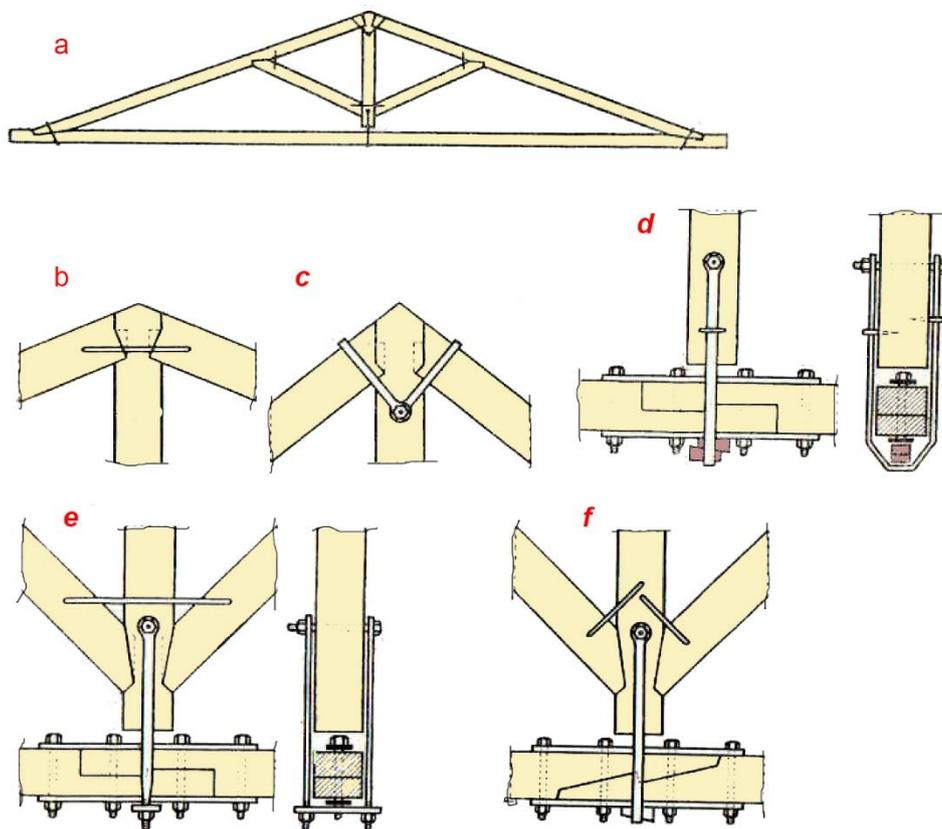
Висячие стропила двускатных крыш пролетом 7.5-13 м: а – общий вид стропильной фермы с подвеской затяжки; б – сопряжение стропильных ног и бабки при малом уклоне ската; с – сопряжение стропильных ног и бабки при большом уклоне ската; d – конструкция подвески с регулируемыми металлическими клиньями; е – конструкция подвески с регулируемой опорной планкой; f – скрепление подкосов и бабки двумя парами малых скоб [33]
